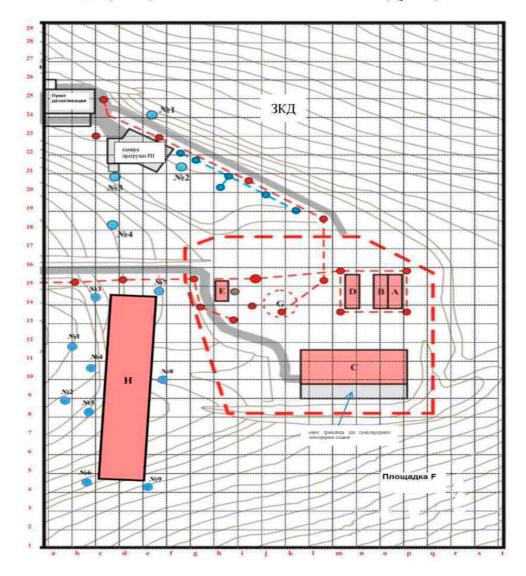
Схема размещения хранилищ РАО на ПХРО Саратовского отделения
